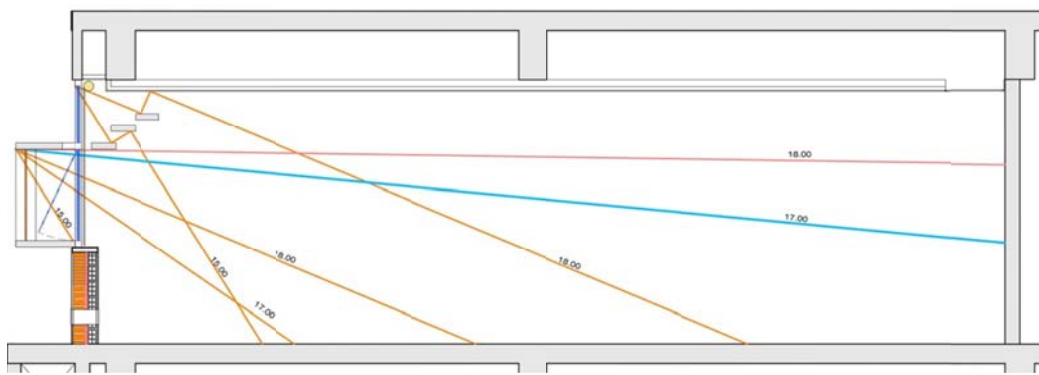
Propuesta de carpintería, parosoles horizontales, verticales móviles y estantes de luz, fachada oeste
